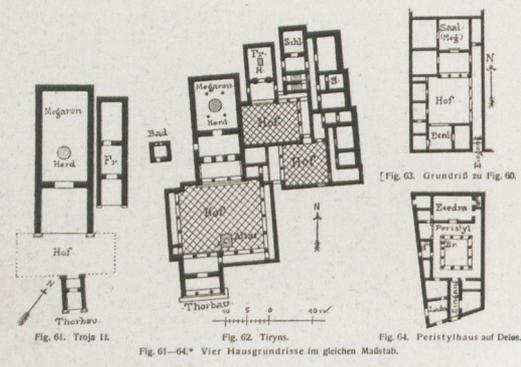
\* Vier Hausgrundrisse im gleichen Maßstab.
